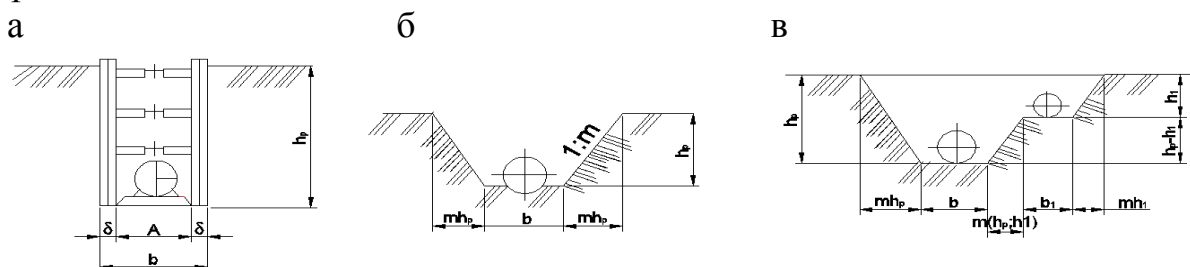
Схемы поперечных разрезов траншей под водопроводные трубы: а – траншеи с вертикальными стенками и креплениями; б – трапециодальных; в – сложного сечения при совмещенной прокладке трубопроводов.
